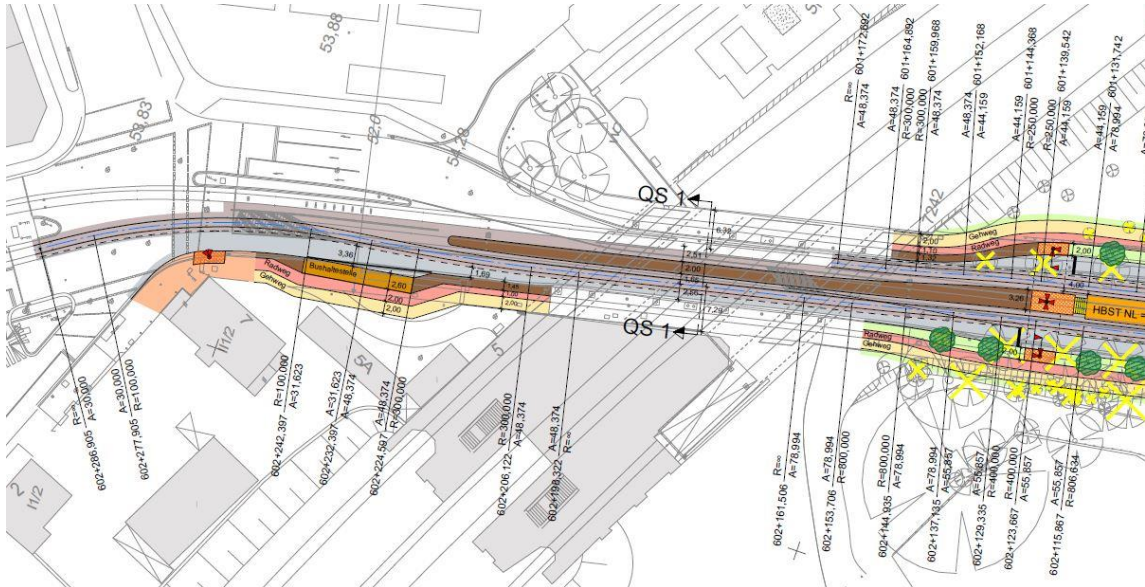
Ausschnitt aus dem Lageplan Variante 5
